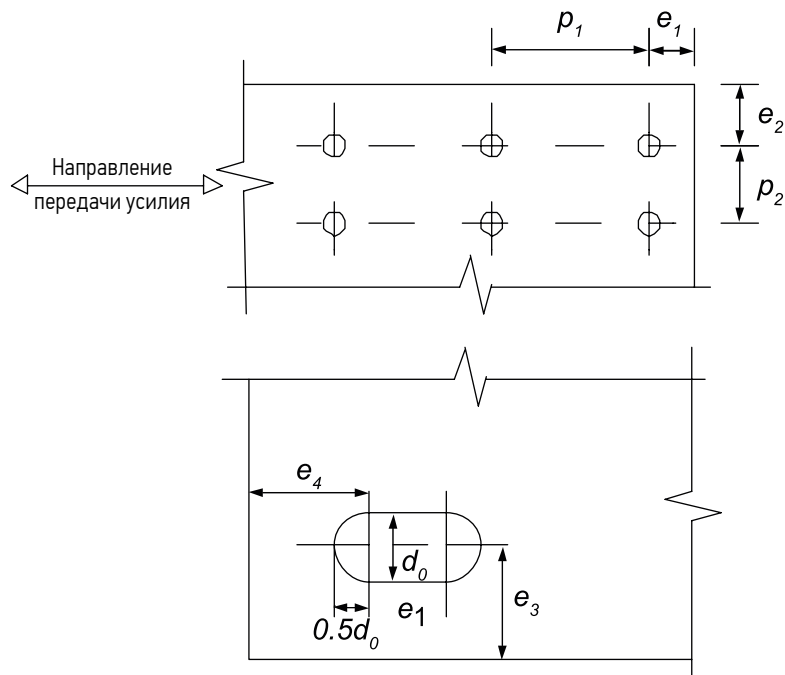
Обозначение расстояний в болтовых соединениях
